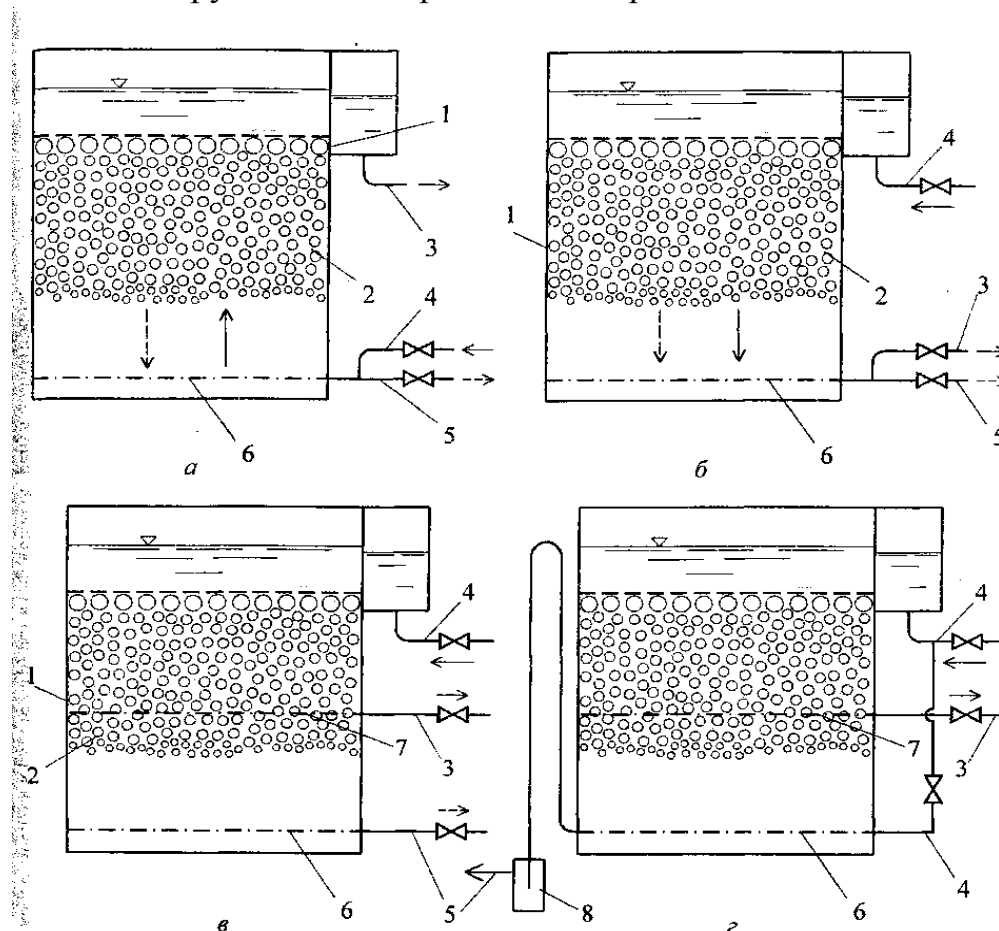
Конструктивные схемы фильтров с плавающей загрузкой
